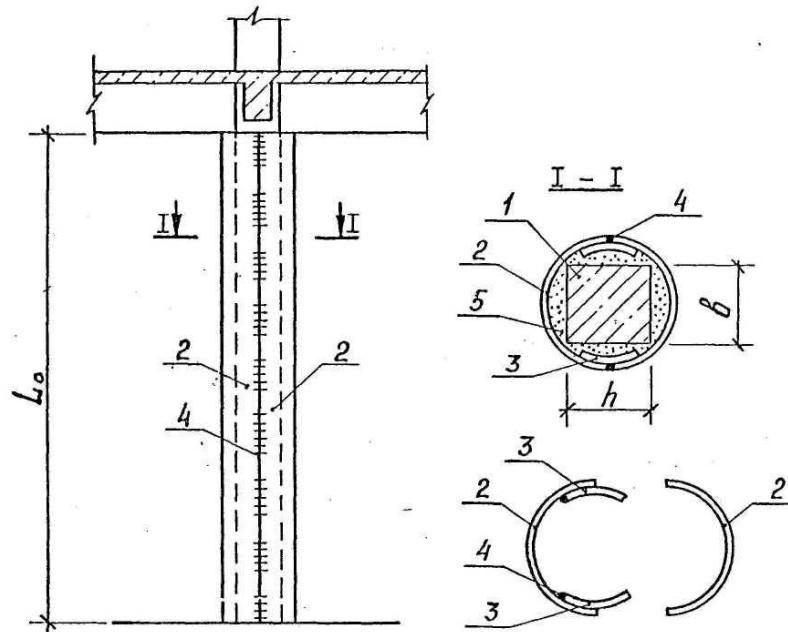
Усиление железобетонной колонны стальной обоймой из листовой стали
